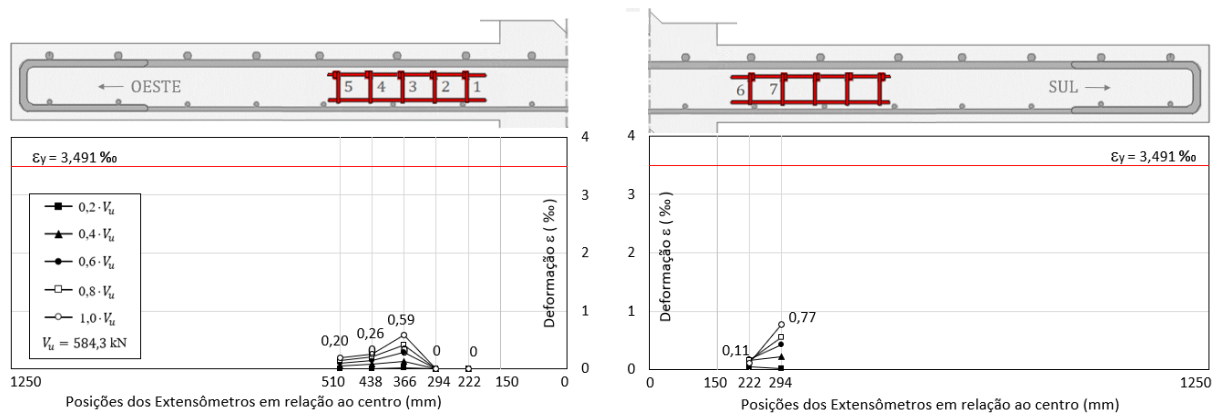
Deformações nas armaduras de cisalhamento da laje NA-05
